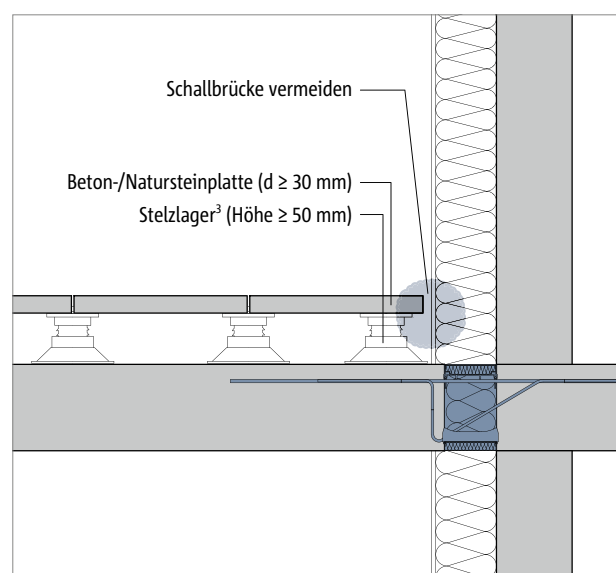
Balkonbelag mit Beton-/Natursteinplatten und Stelzlager
